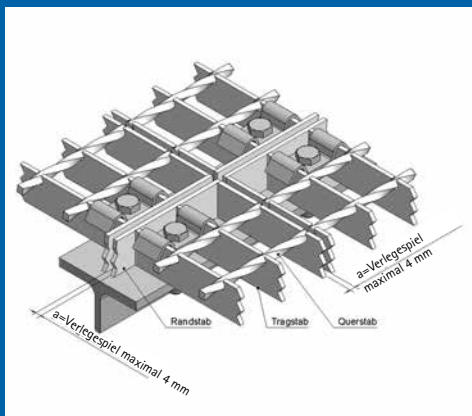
Verlegespiel zwischen vier Schweißpressrosten
